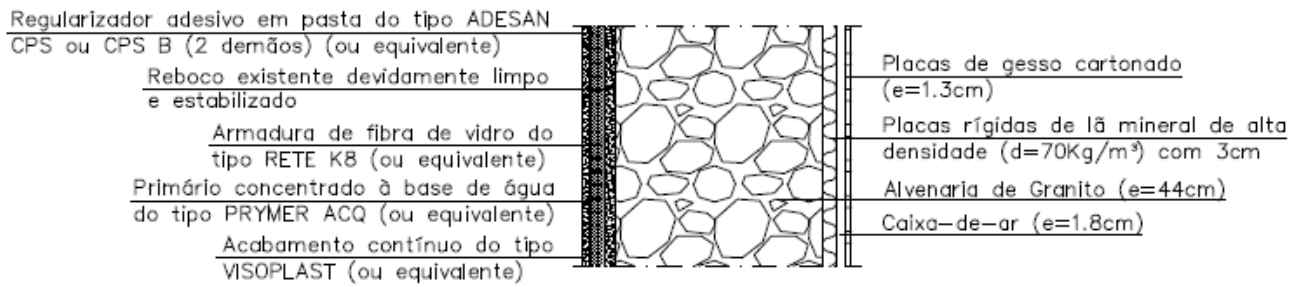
Pormenor construtivo da parede exterior de fachada (Projeto de CT)
